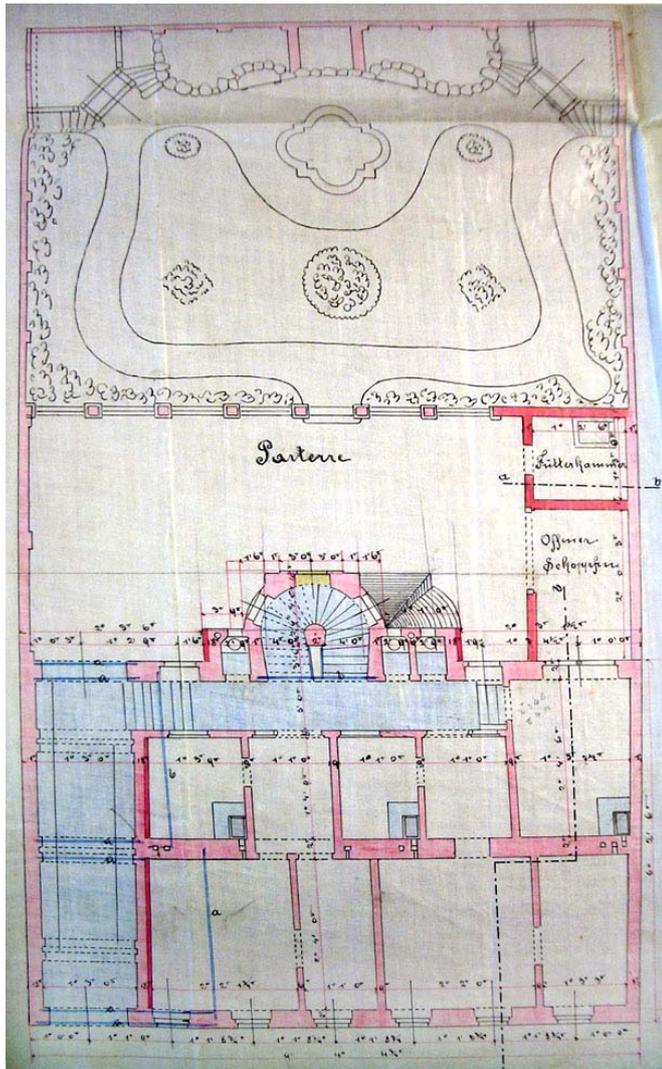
Zinshaus in Wien-Leopoldstadt. Grundriss und Plan der Innenhofanlage. 1879. Einreichplan.
